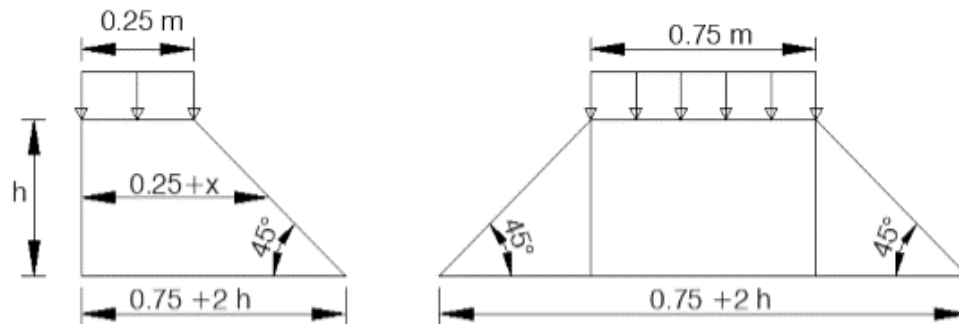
Poussée d'une charge locale située à l'arrière du mur.
